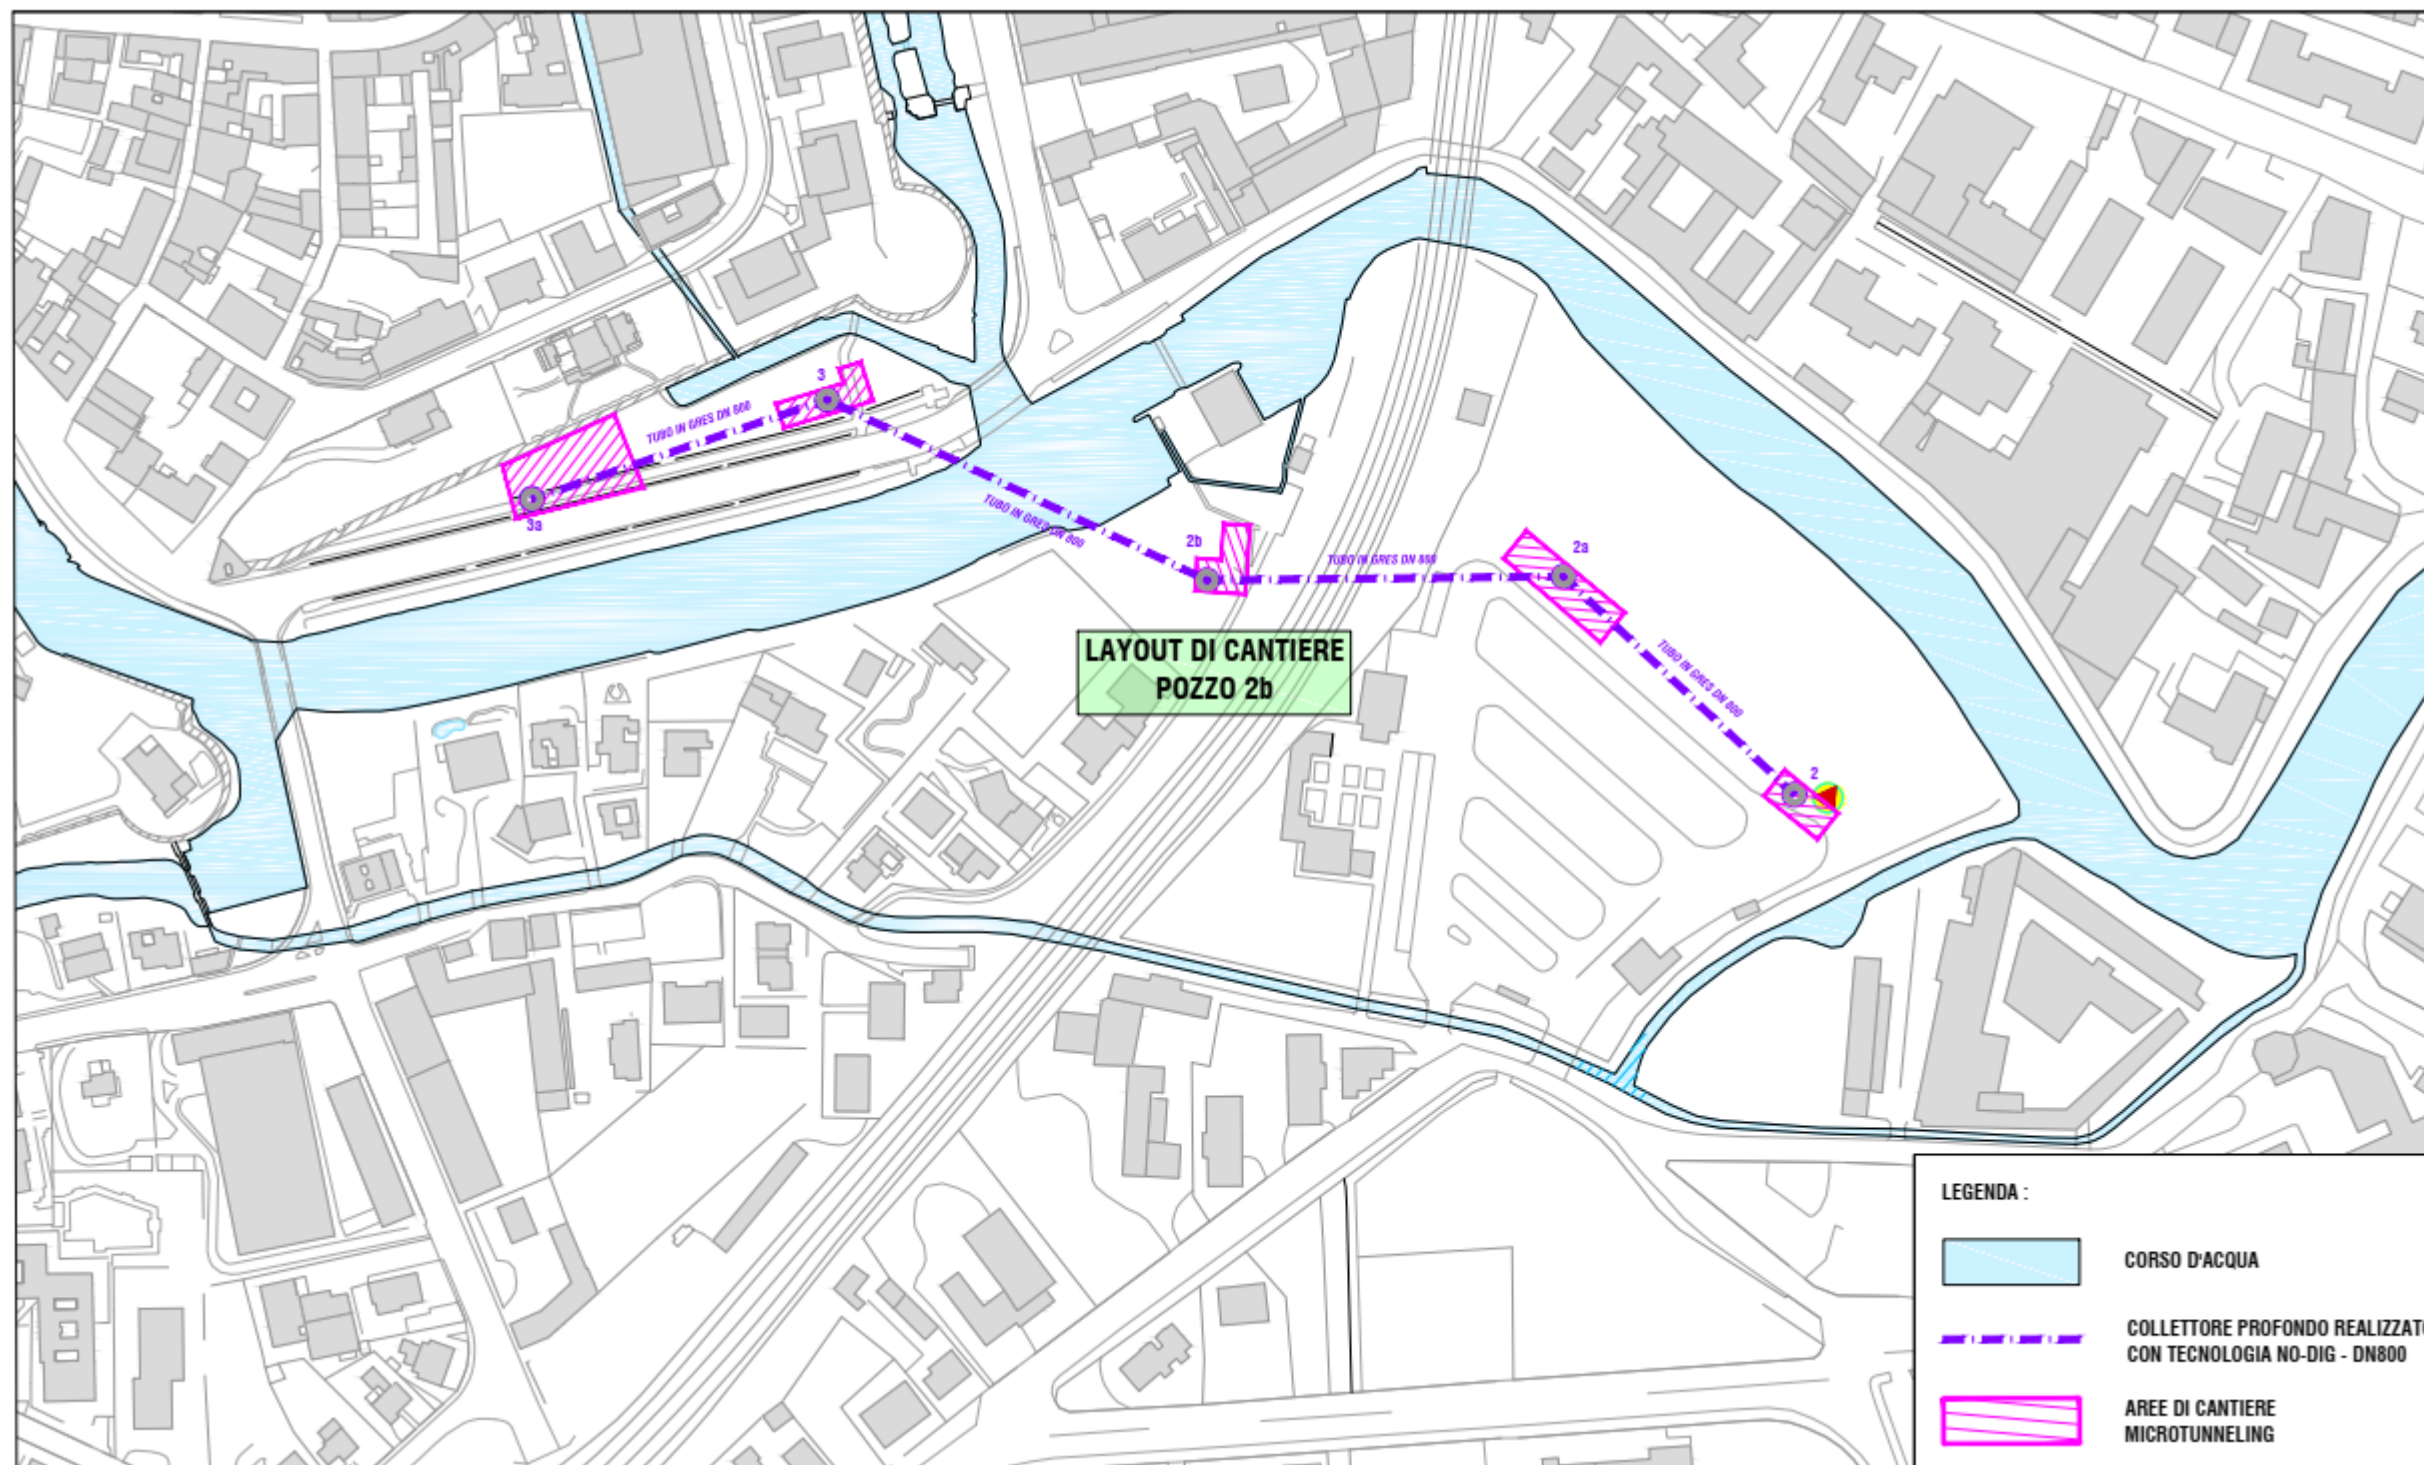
O : Inquadramento planimetrico area cantiere POZZO S02b
